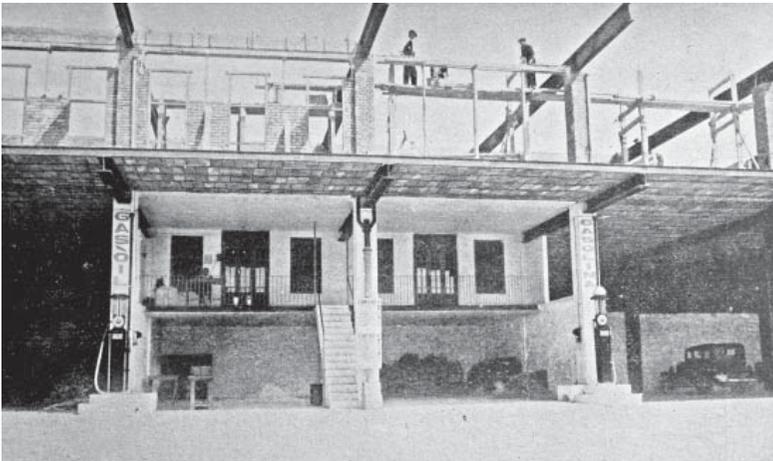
Edificio de recepción en construcción. Vista aparcamientos.
